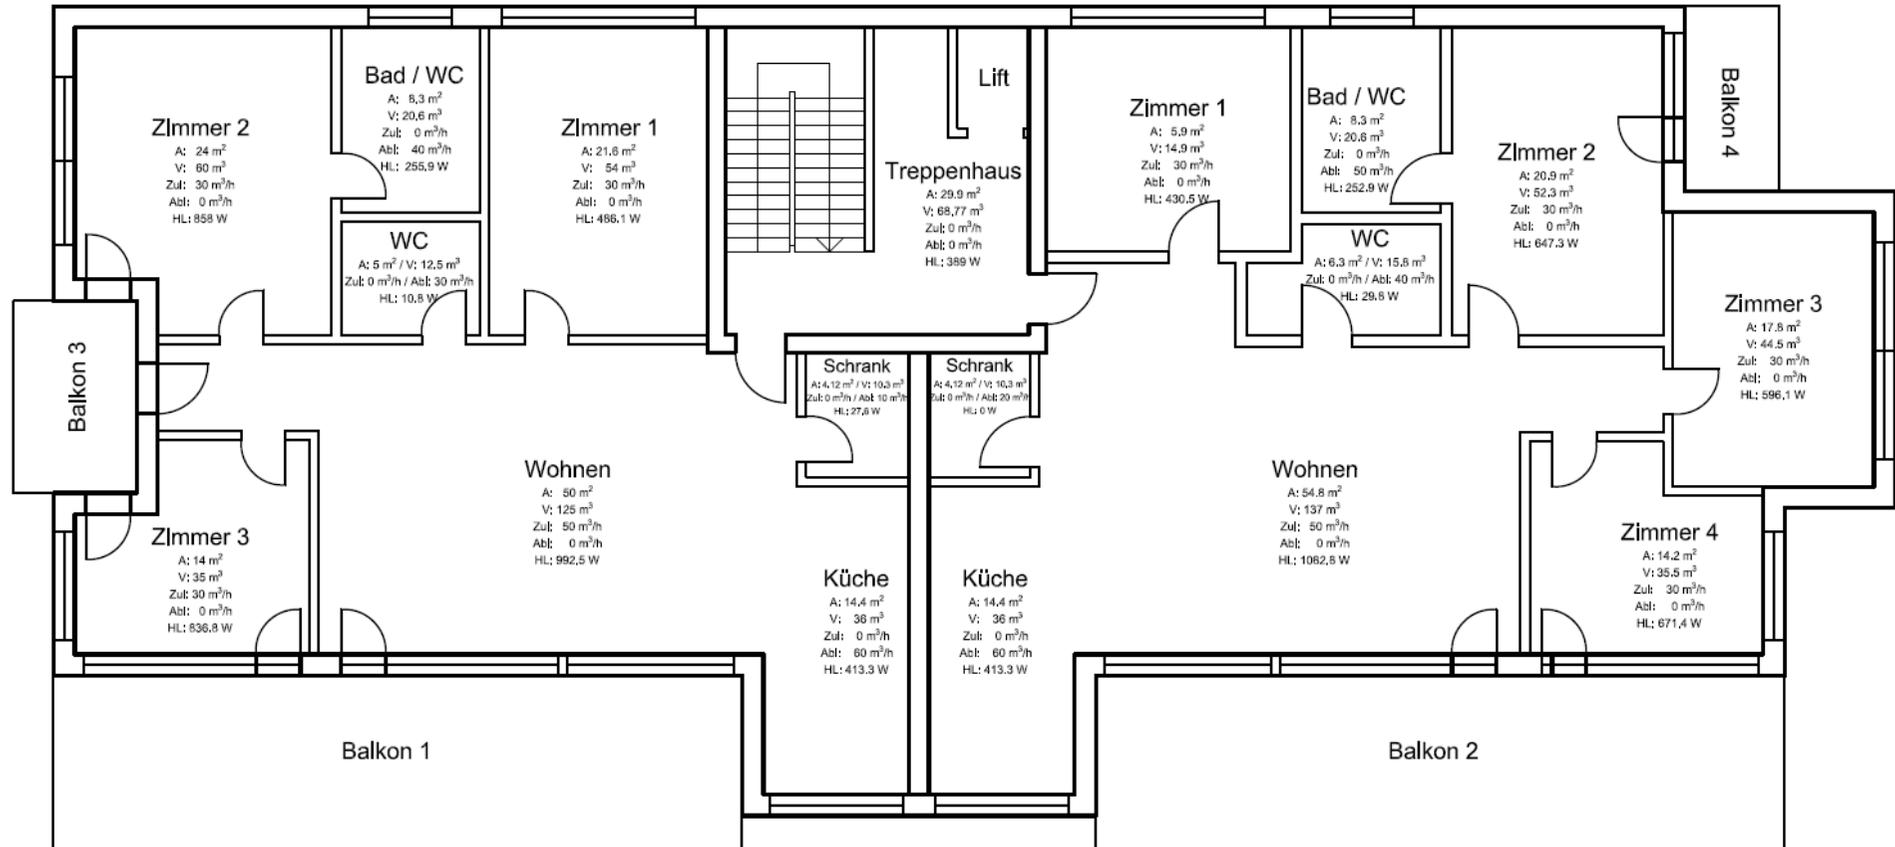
Grundriss des Obergeschosses mit Heizleistung nach SIA 384.201.
